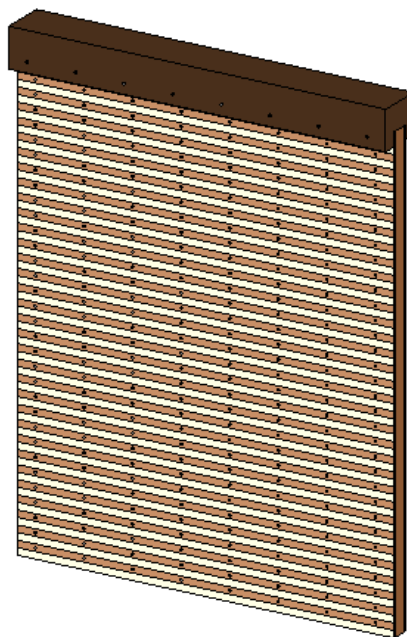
Pormenor de construção da estrutura resistente de um pavimento de madeira (piso superior) – colocação de frechal superior
